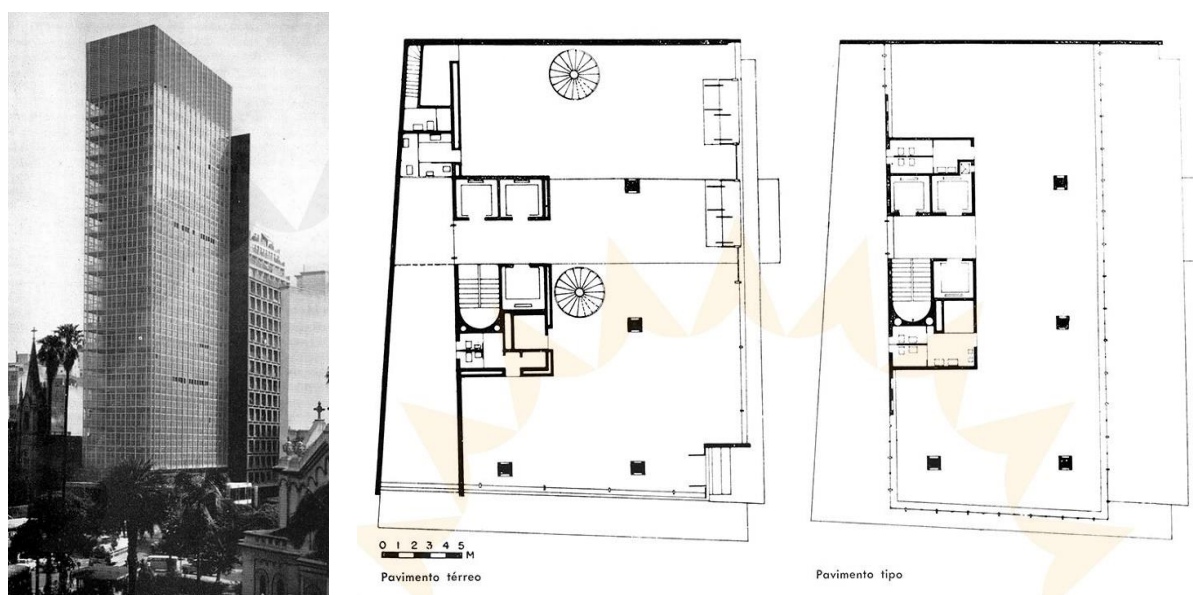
Vista do edifício Wilton Paes de Almeida e plantas dos pavimentos térreo e tipo (fonte: Revista Acrópole, 1965)
